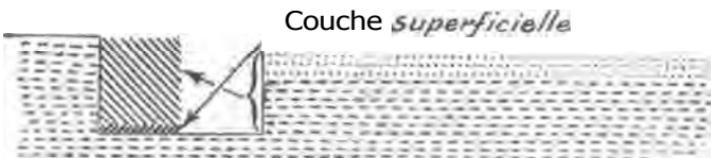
Coupe du terrain après le creusement de la deuxième tranchée.
